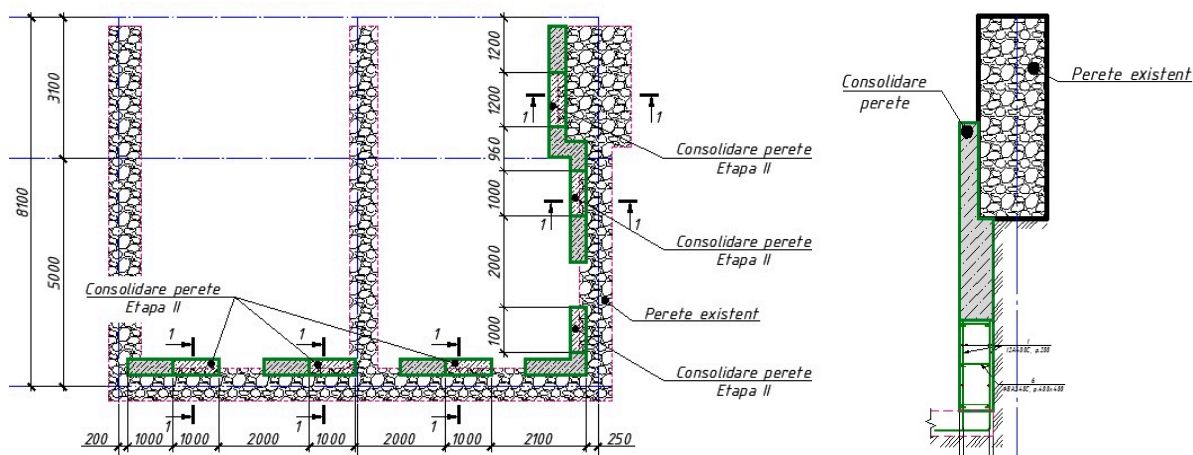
Exemplu de realizarea unui perete din beton armat lângă cel existent [5]
